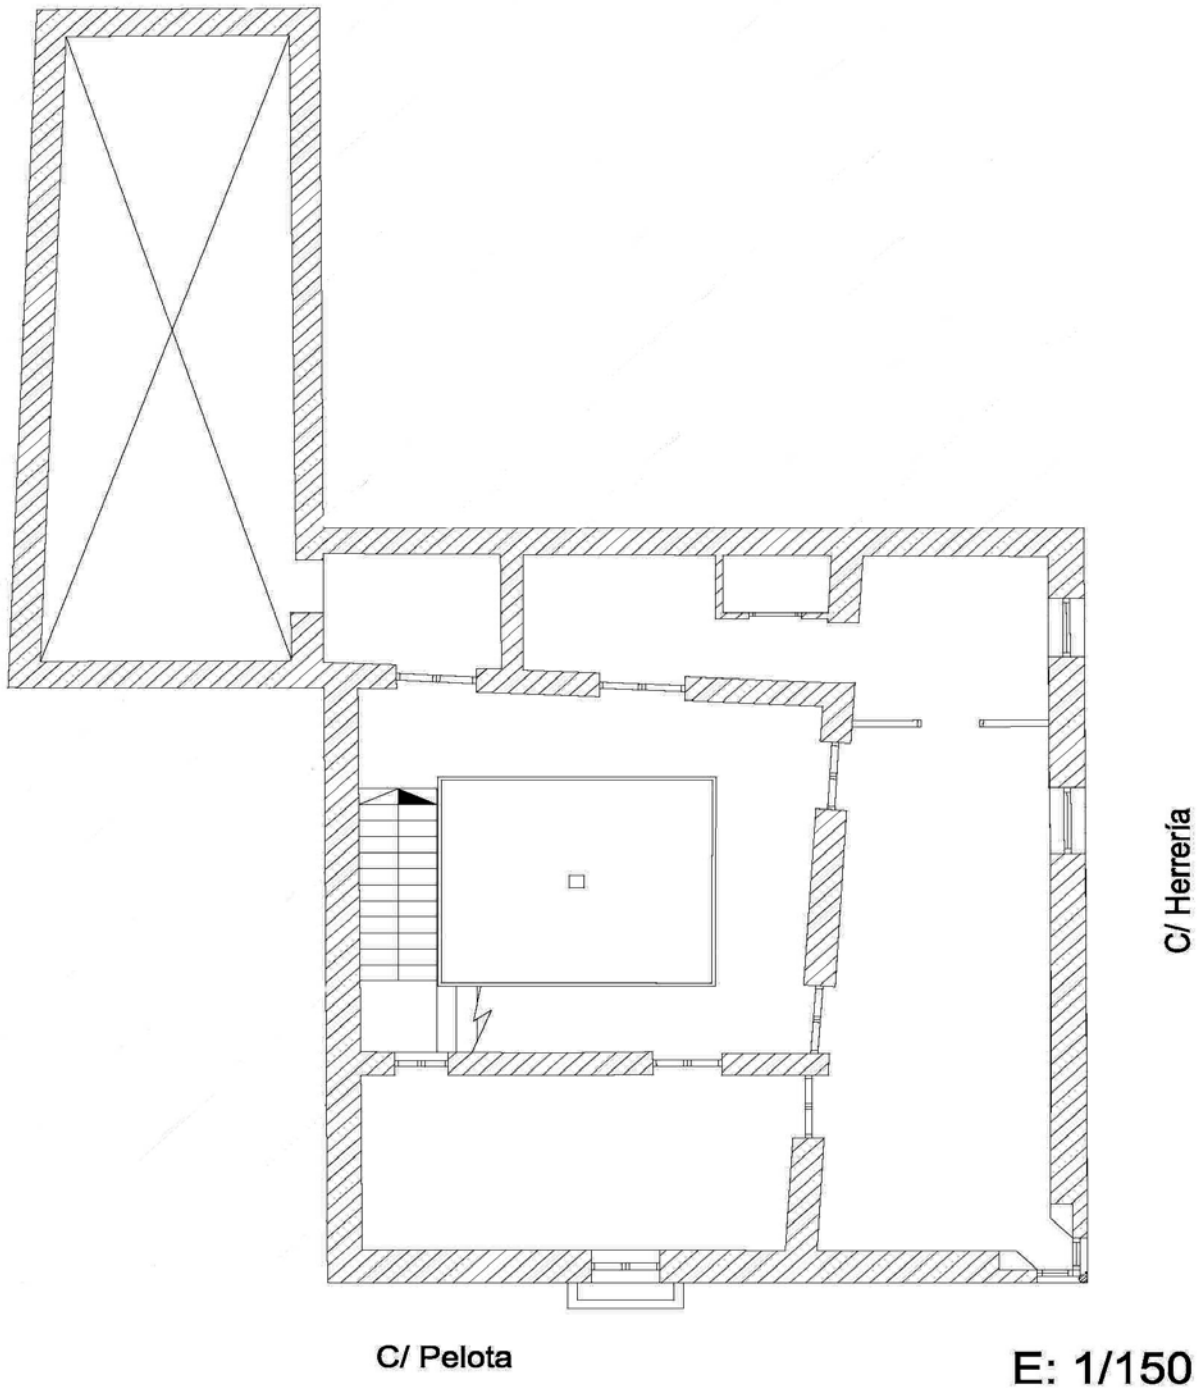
Planimetría de la Casa del Deán: planta primera. (Procedencia gráfica: Padrón & Trujillo Arquitectos).
